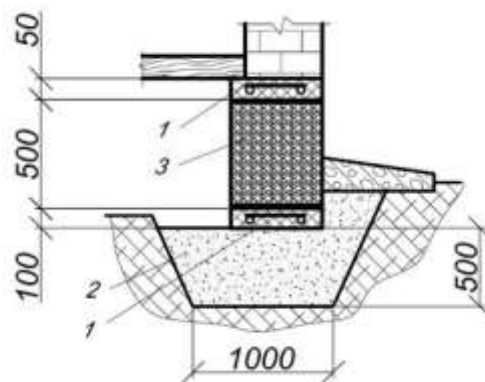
1 – железобетонные блоки; 2 – монолитный железобетон; 3 – песчано-гравийная смесь.
